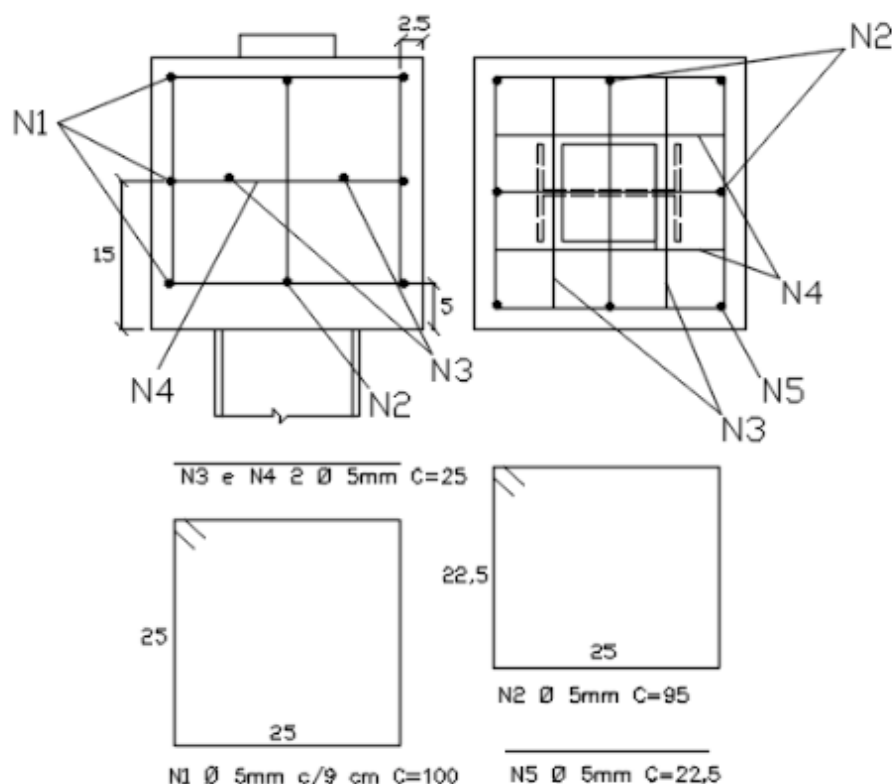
Detalhamento da armadura A1. Vista lateral e superior, autores (2017).
